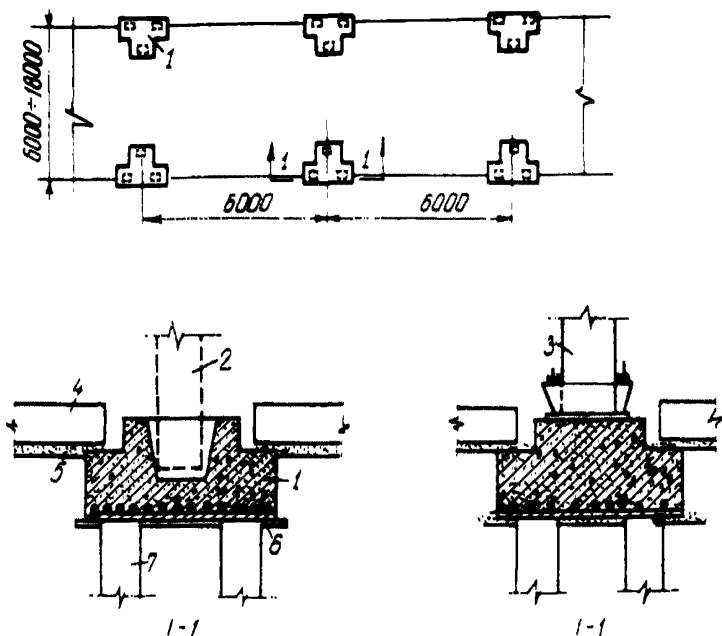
Свайные фундаменты с монолитными ростверками под железобетонный и стальной каркасы зданий:
